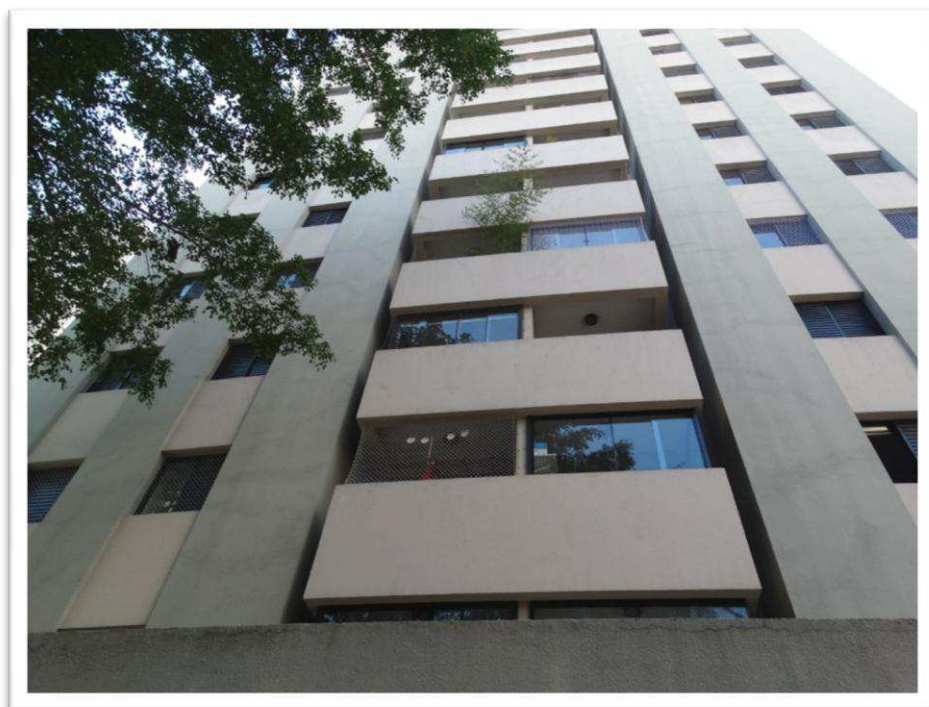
Vista da Fachada frontal do Bloco “B”, onde situa-se o apartamento nº 82, objeto da lide.
